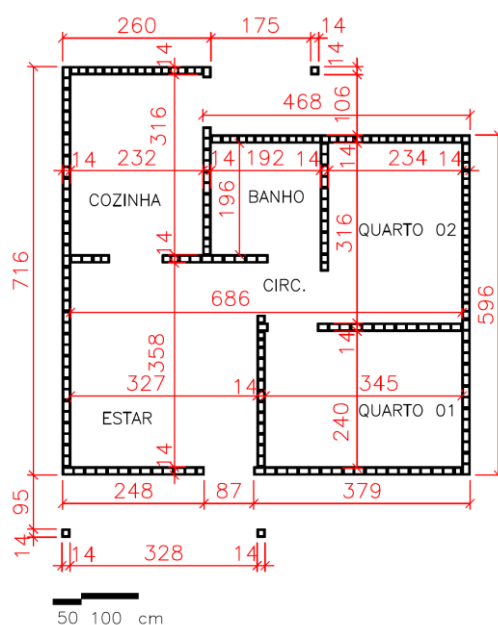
11 - Planta 1ª fiada alvenaria estrutural modular
